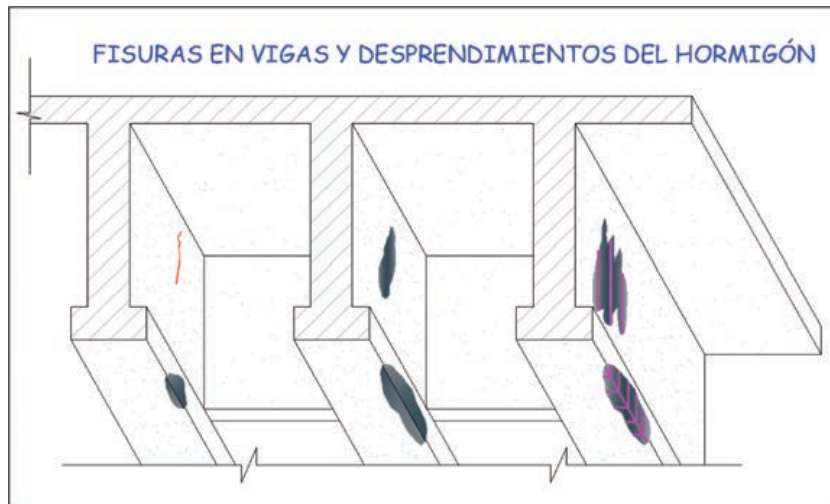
PROGRESIÓN DE LA FISURACIÓN DEL HORMIGÓN Y POSTERIOR DESPRENDIMIENTO DEL HORMIGÓN.
